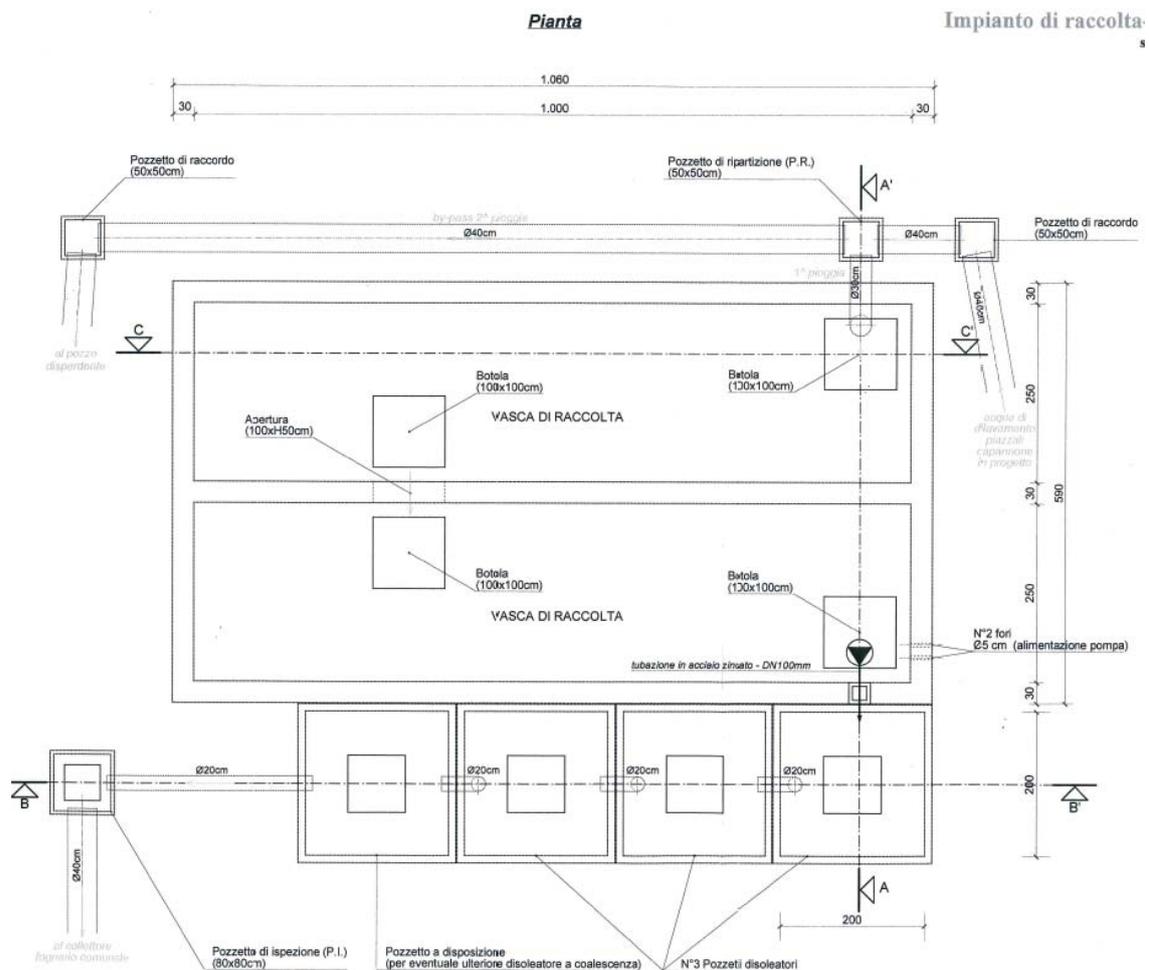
Pianta dell'impianto di depurazione prima pioggia
